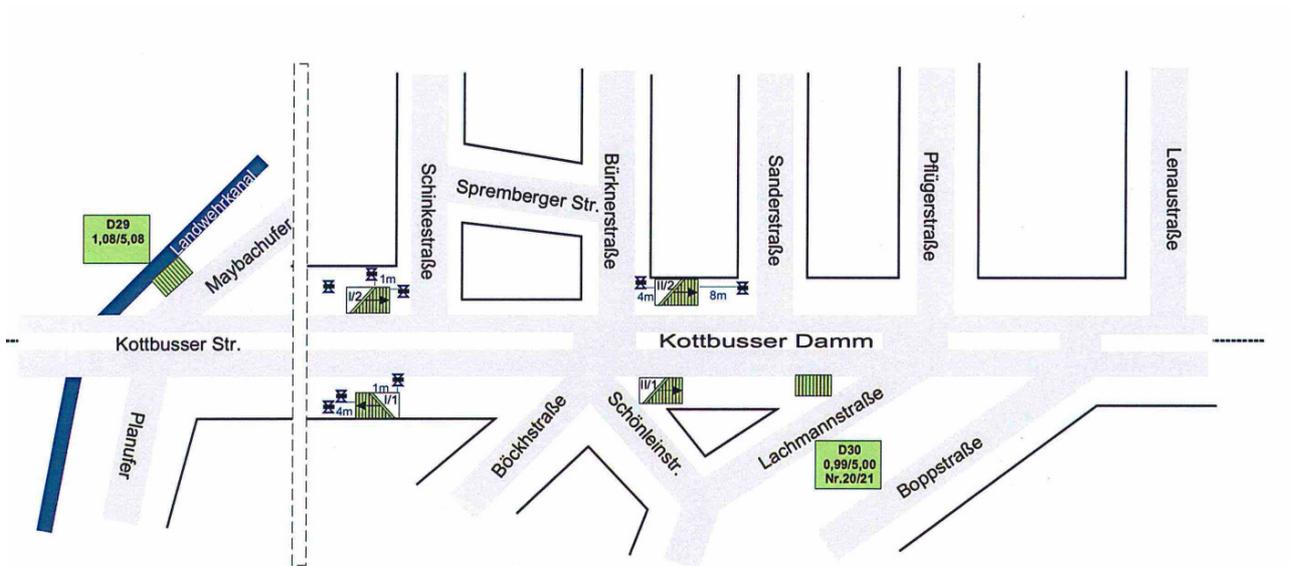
Lageplan vom U-Bahnhof Schönleinstraße
